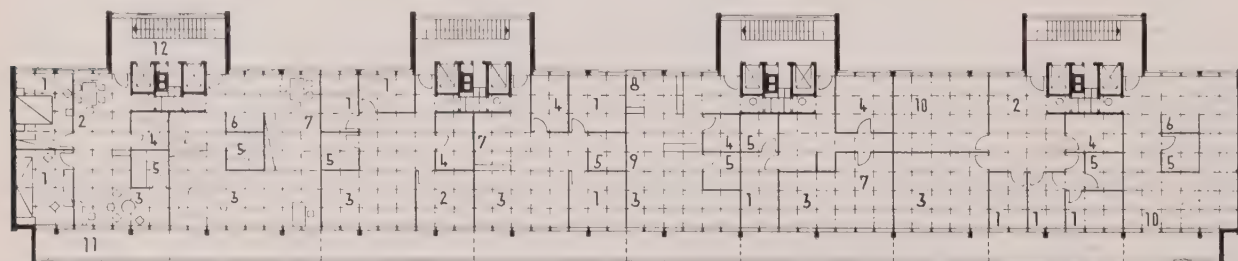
Grundrißschema eines neungeschossigen Scheibenhauses 1:450
